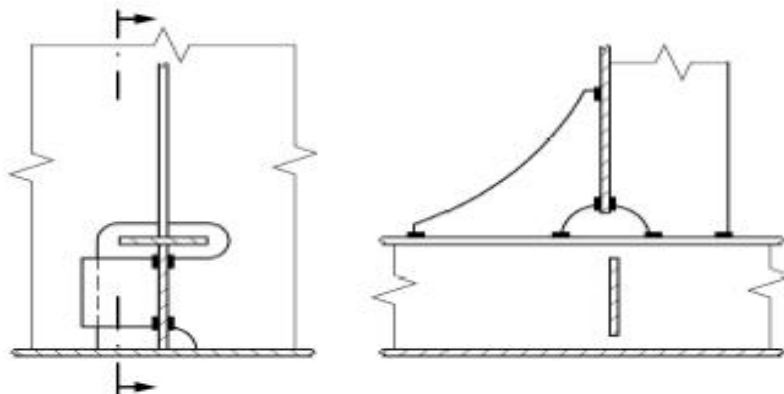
Detalle estructural (elemento longitudinal y atiesador). Ref. [26]
